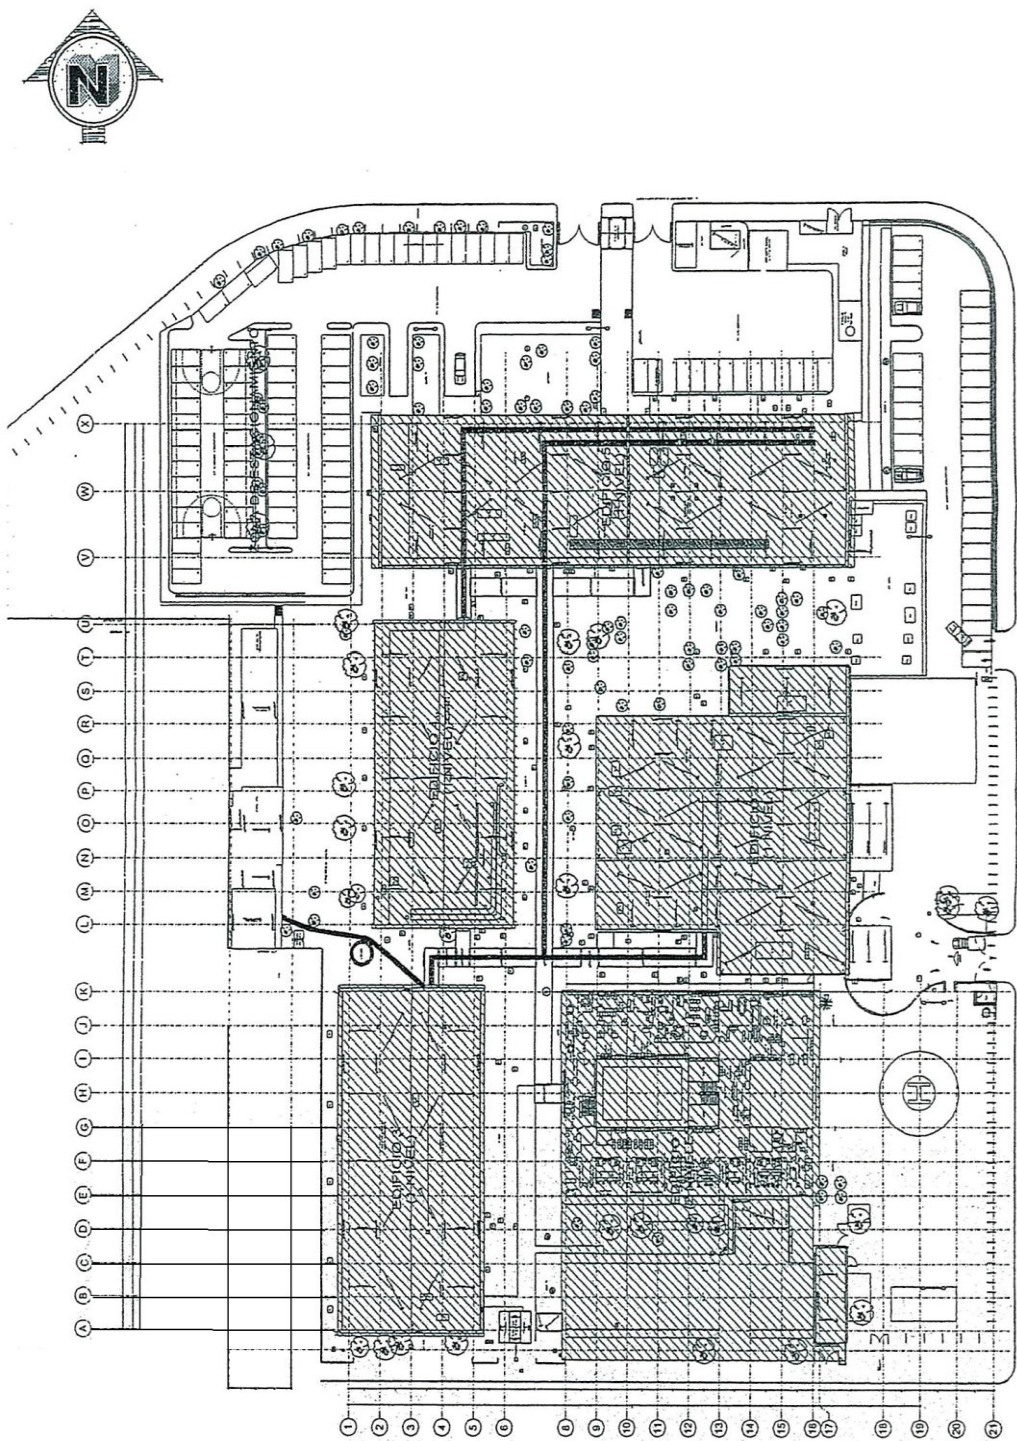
PLANTA ARQUITECTONICA DEL ESTADO ACTUAL DEL HOSPITAL (PLANTA ALTA).
